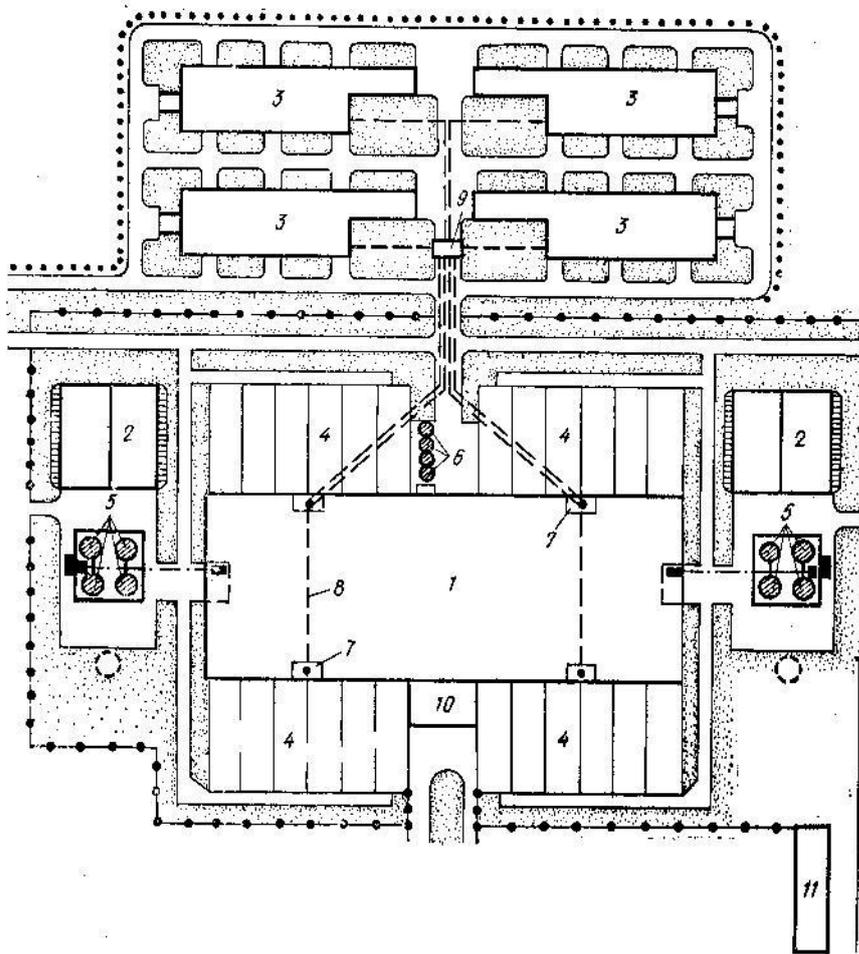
Фрагмент генерального плана комплекса:
